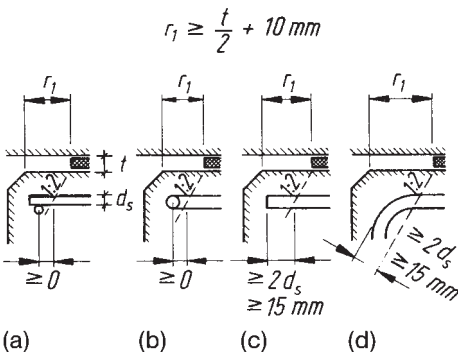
Bewehrungsführung im Auflagerbereich bei unbewehrtem Elastomerlager (nach [218])
